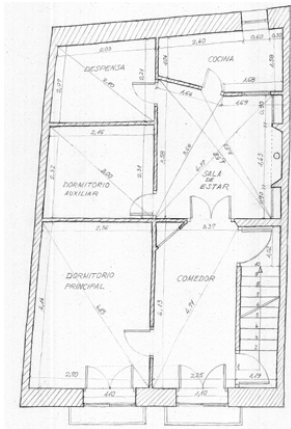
Planta C/ Sense Cap nº11, Vistabella. 2011. Alumna: Gabrilescu S (Grupo 9)
